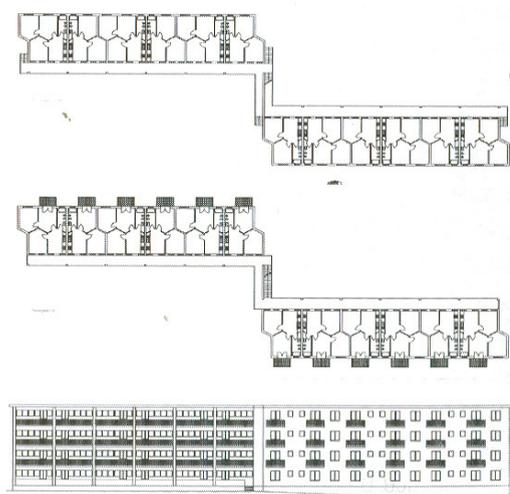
Rione S. Gaetano, comparto IV, planimetria, piante tipologiche e prospetti.
